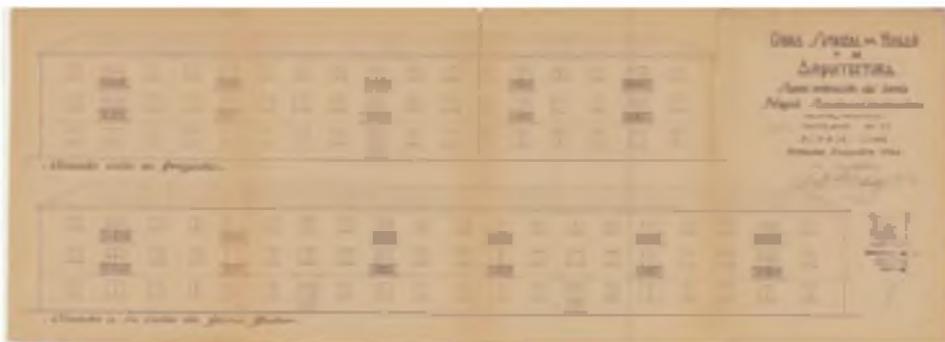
Grupo Barrio El Hogar Nacional Sindicalista. 2ª Fase: Alzados manzana 2ª. Caja nº 44.
